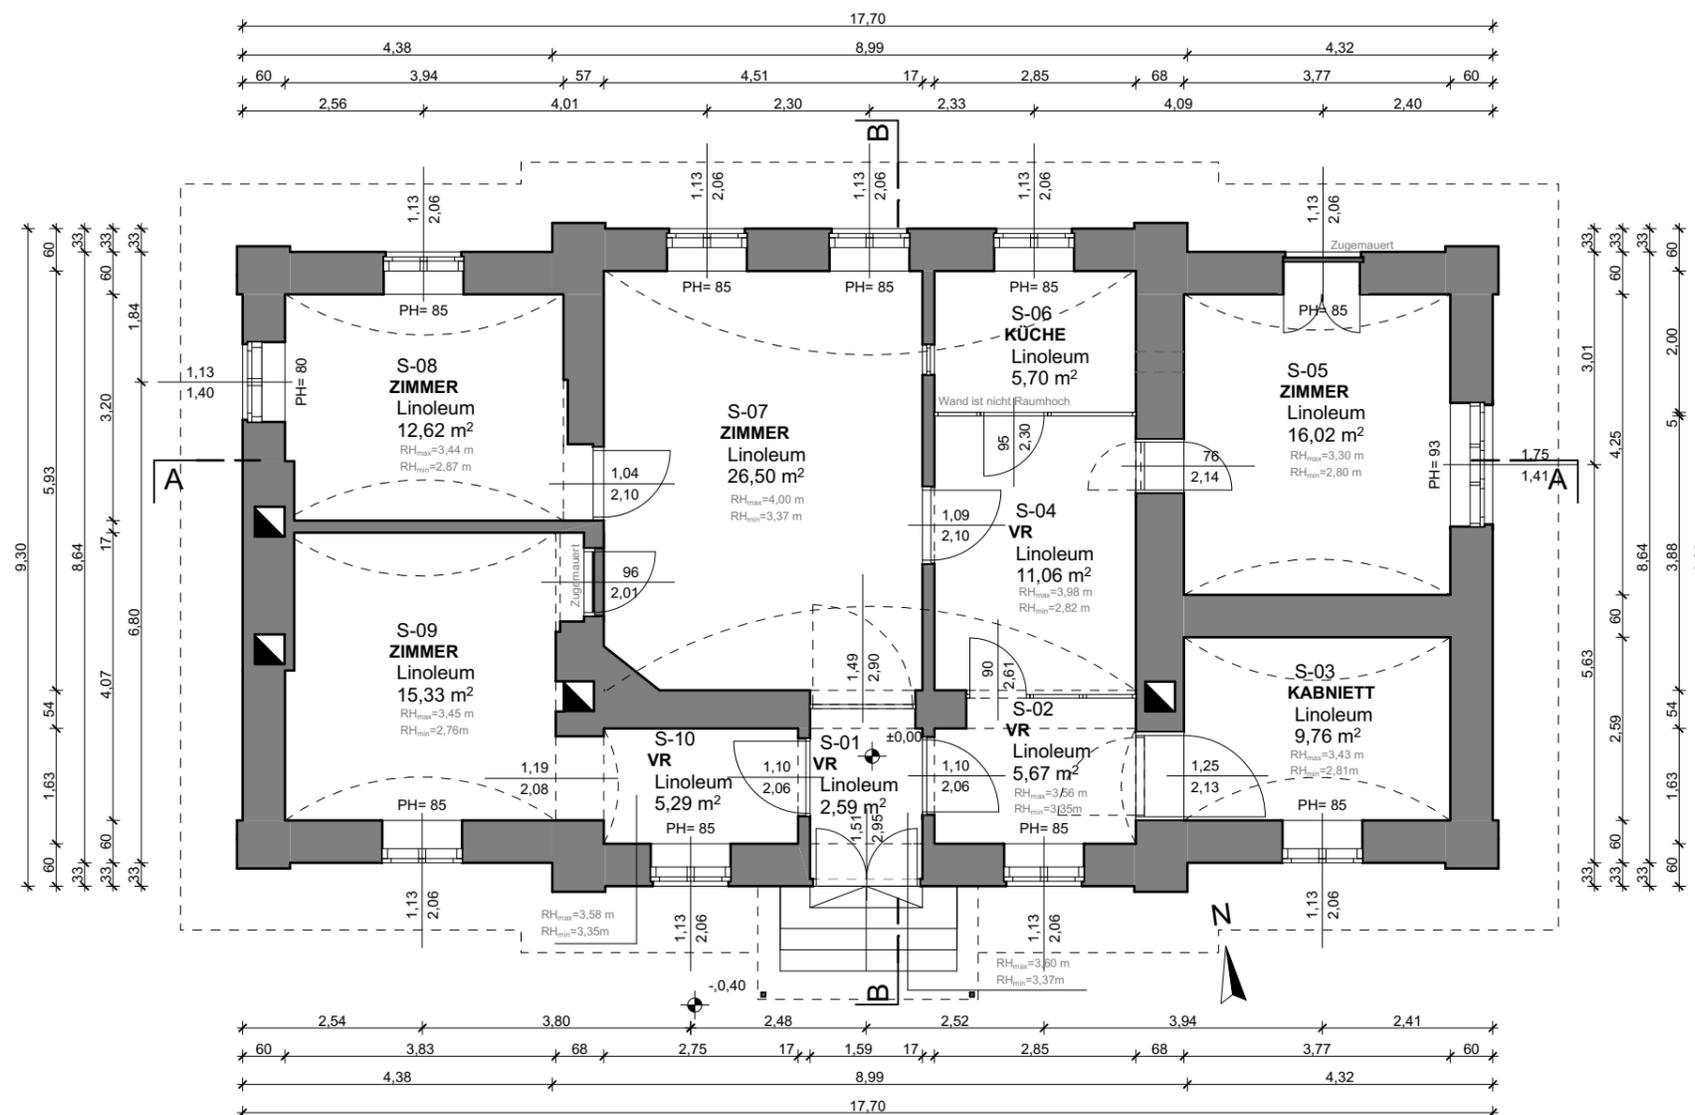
Bestandsplan: Grundriss des kleinen Schlosses
